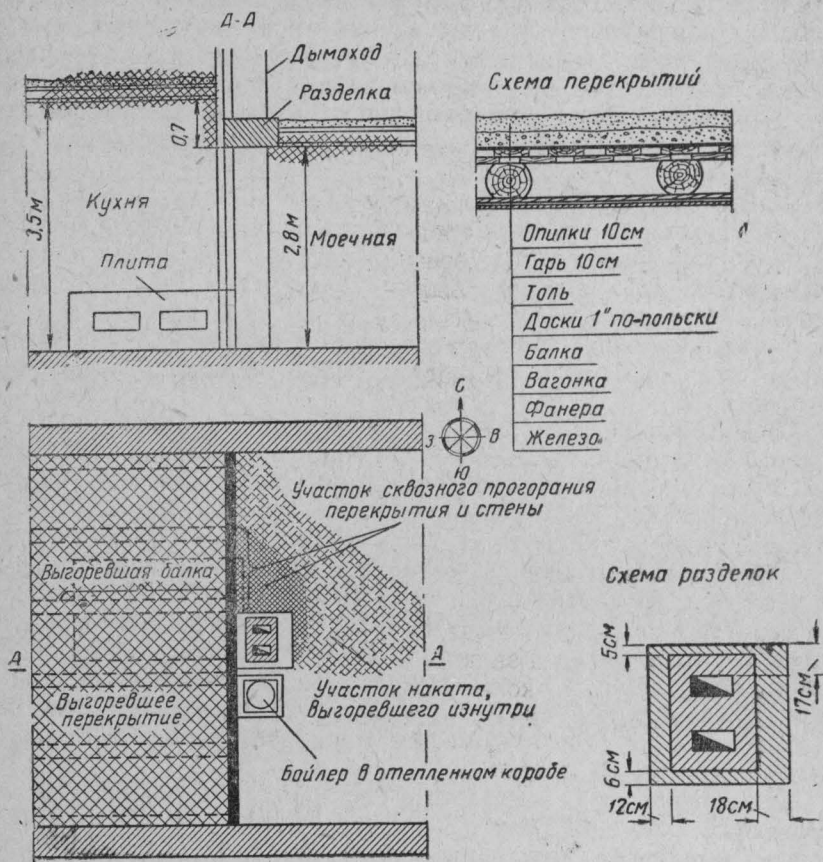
Схема расположения плиты и дымохода и разрушения конструкций на участке очага пожара.
